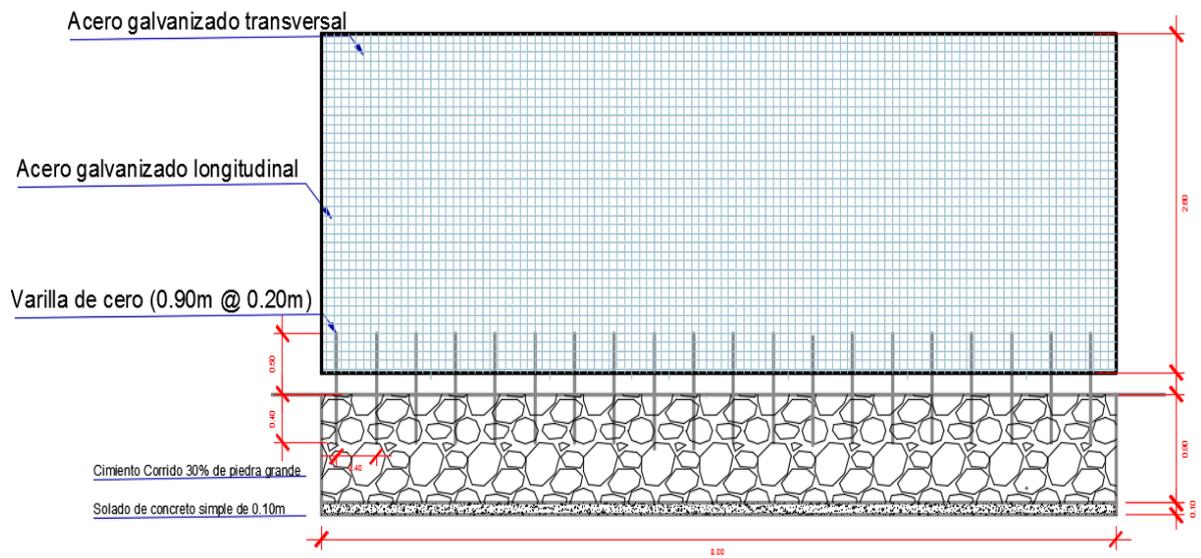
Etapa 02. Montaje del panel a la cimentación.
